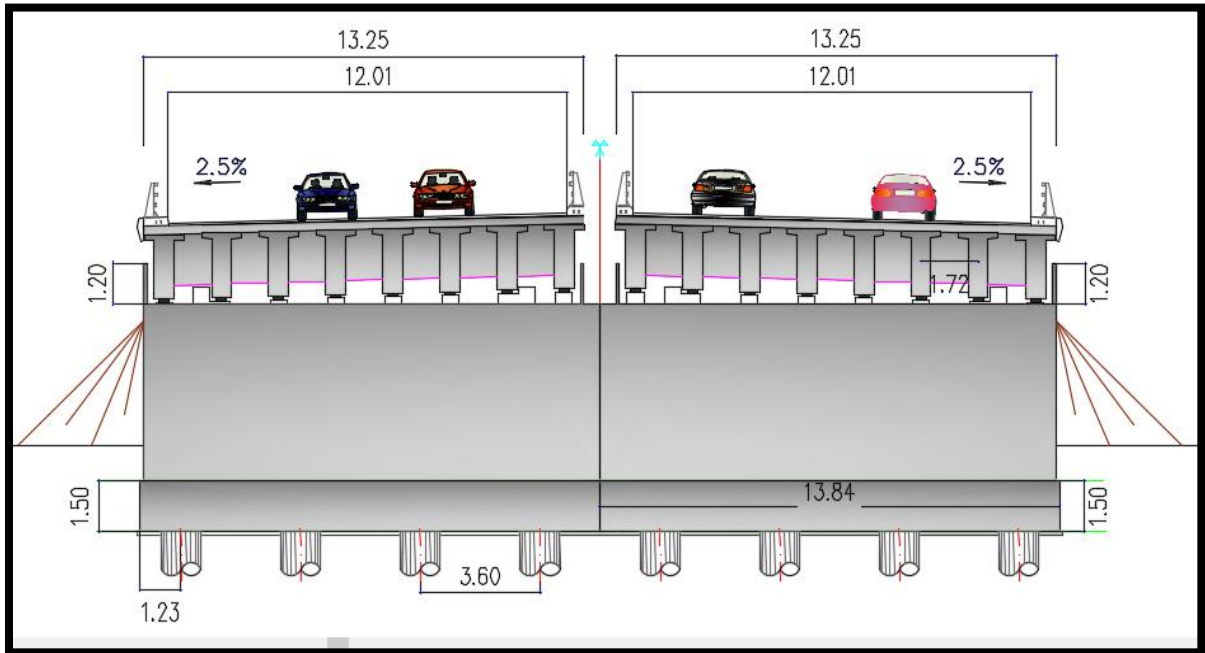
Coupe transversale sur culée VARIANTE 01
